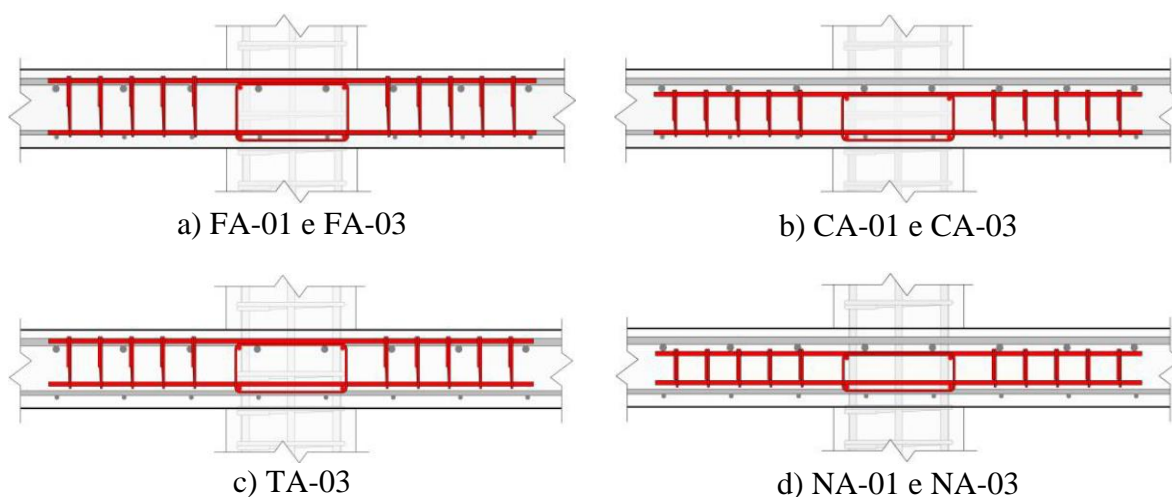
Resumo das características das lajes (Adaptado de Palhares, 2018)
